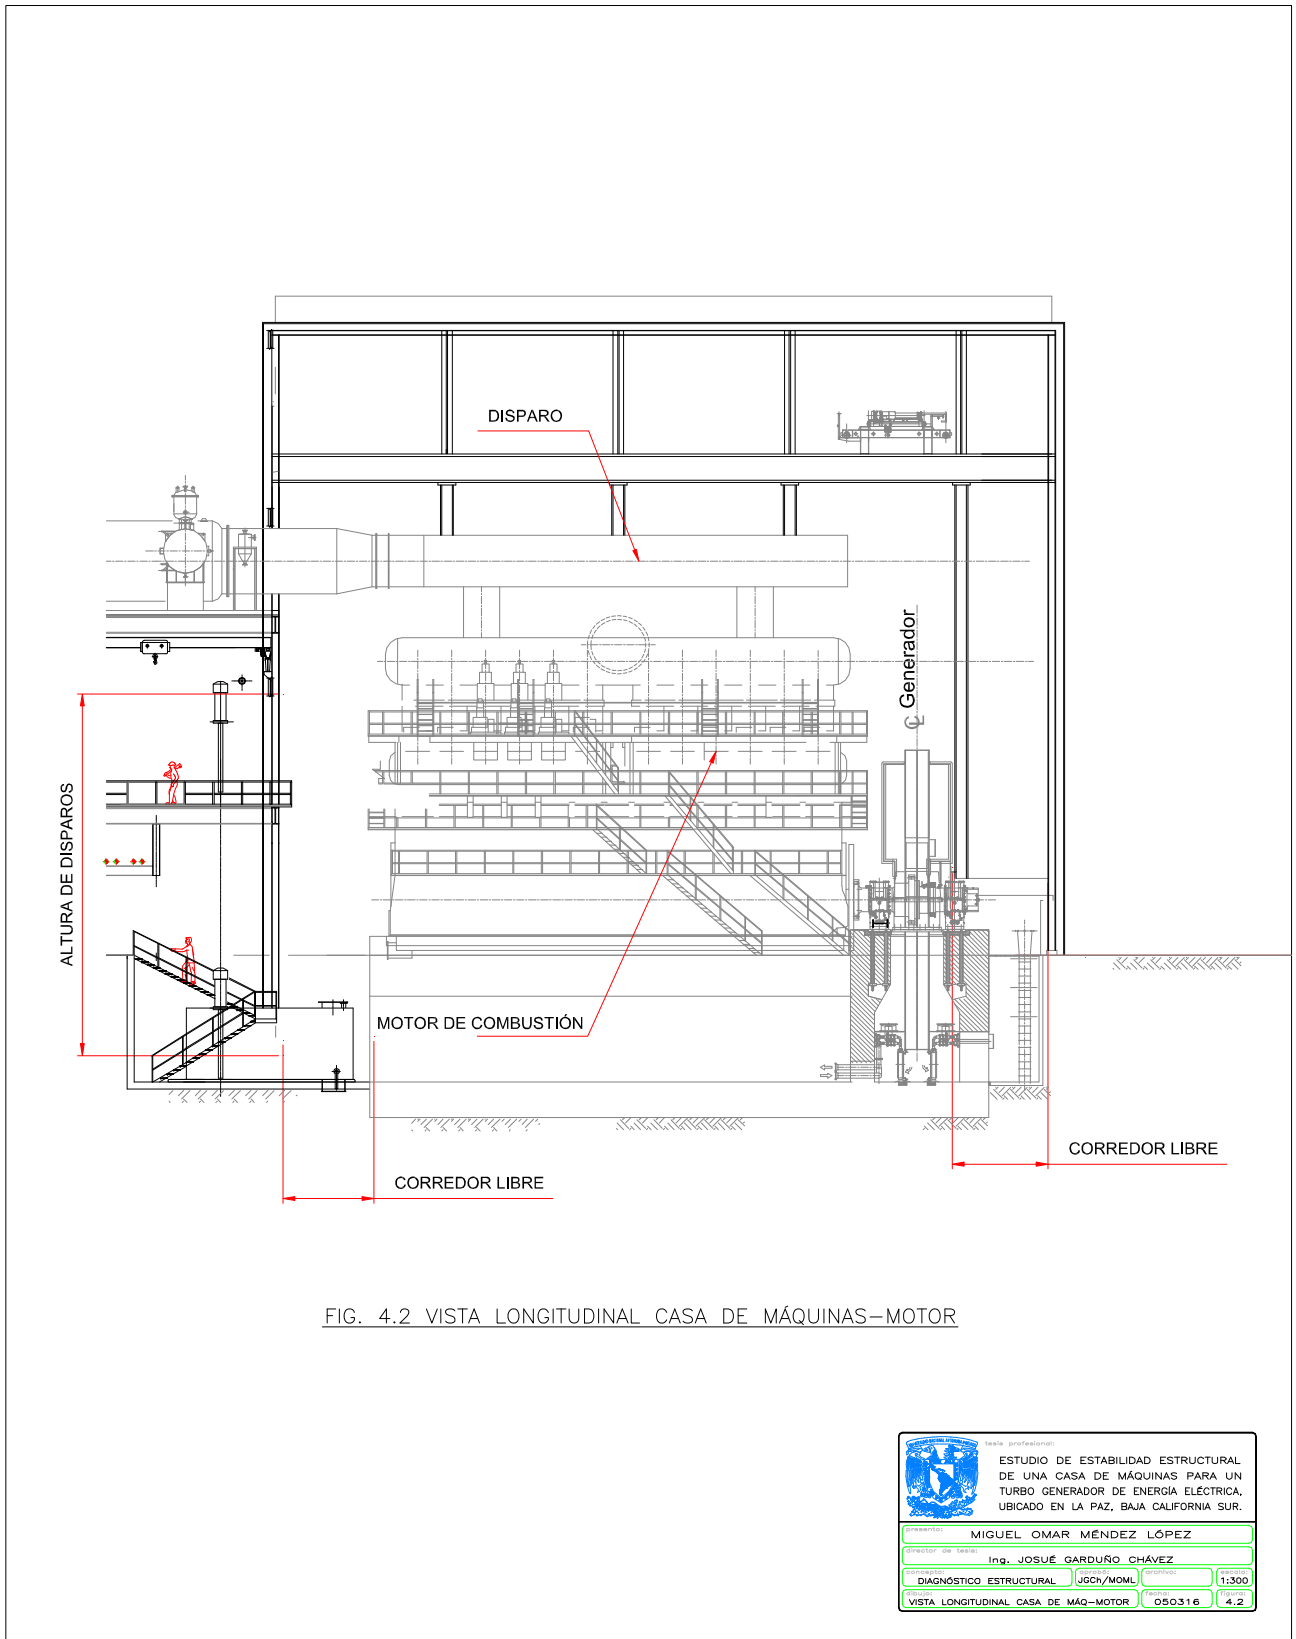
VISTA LONGITUDINAL CASA DE MÁQUINAS-MOTOR
